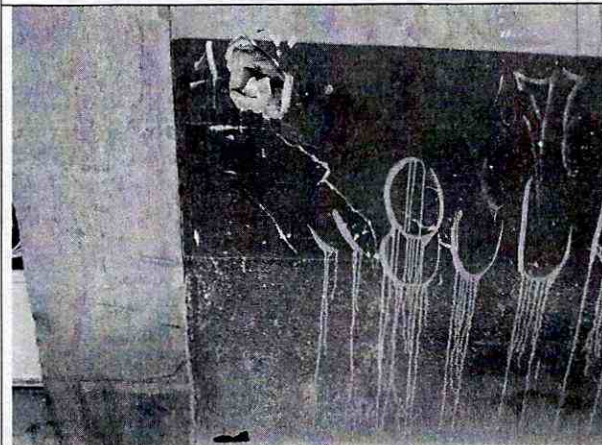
Fisuras en la superficie del muro, parte baja.
